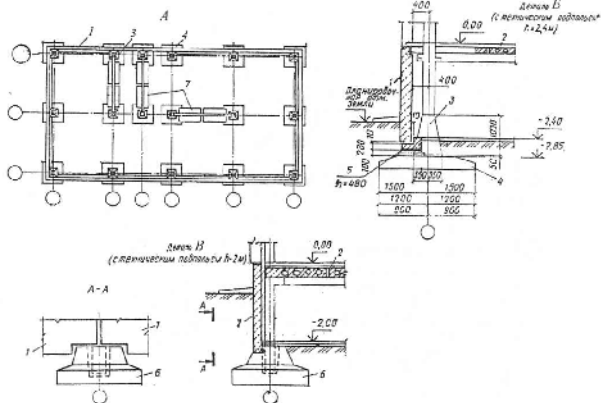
Фундаменты каркасно - панельного здания: А - схема плана; Б, В - детали опирания колонны на фундаментные пирамидки (Б) или на фундаментные стаканы (В); 1 - наружная цокольная панель; 2 - цокольное перекрытие; 3 - пирамидальное основание колонны; 4 - фундаментная подушка; 5 - фундаментная балка; 6 - фундаментный стакан под колонну
